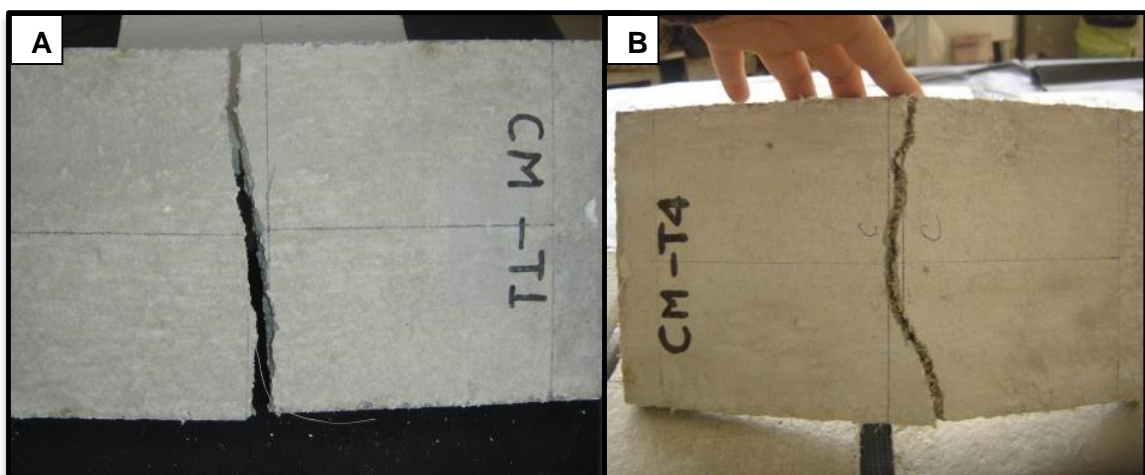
Fisuración de muestra de cemento con celulosa de papel (A), fisuración de muestra de cemento con celulosa de papel y fibra de Abacá (B).
